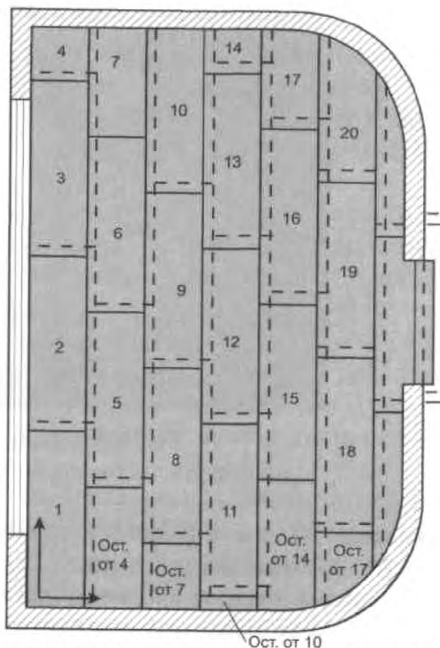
Укладка элементов пола от стены, противоположной стене с дверным проемом.
